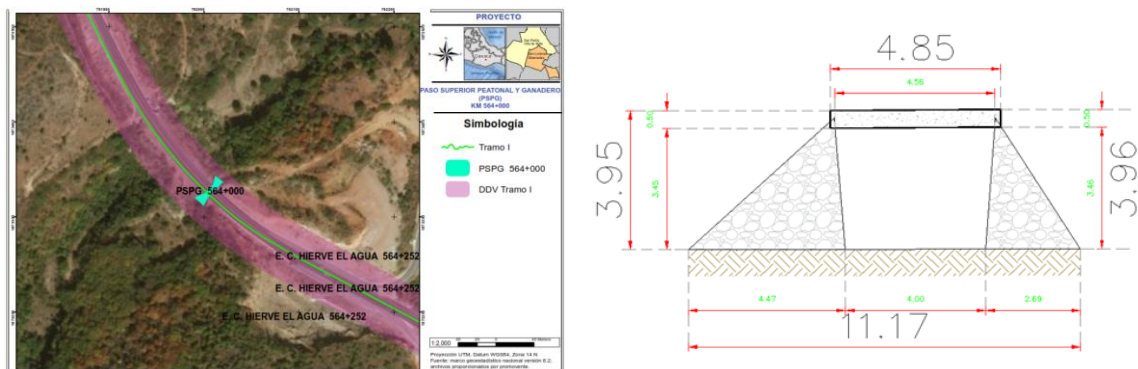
Proyecto en planta y corte transversal del PSPG 564+000.
